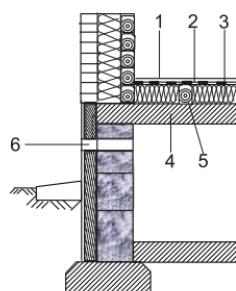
Вентиляция подвала: 1 — покрытие пола из досок; 2 — пароизоляция; 3 — теплоизоляция; 4 — плита перекрытия; 5 — деревянные лаги; 6 — вентиляционный продух; 7 — утепление стены
